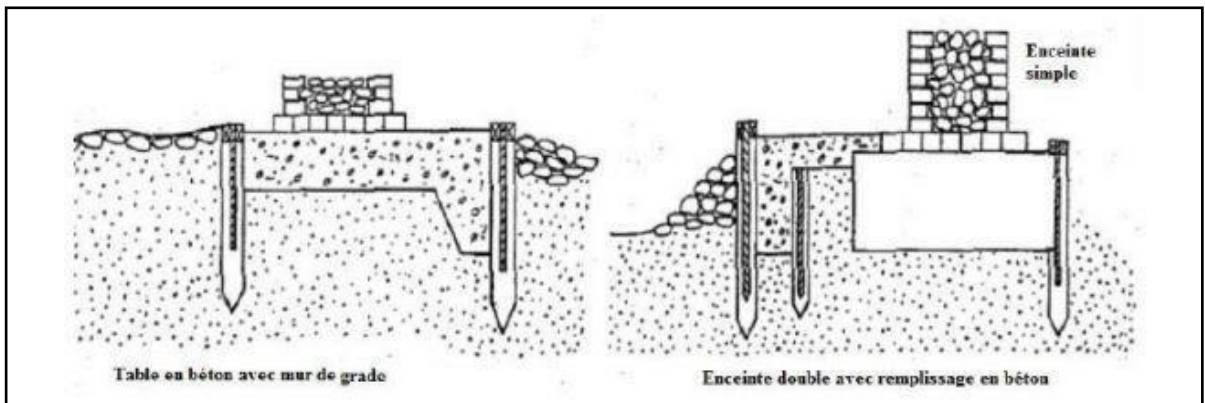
La protection d'un appui par rideaux para-fouilles.
